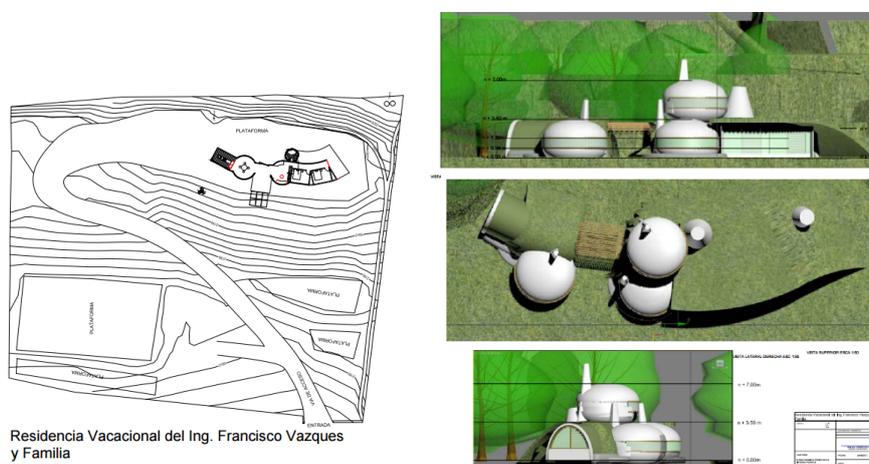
Emplazamiento y forma de la vivienda (Archivo de autor)
